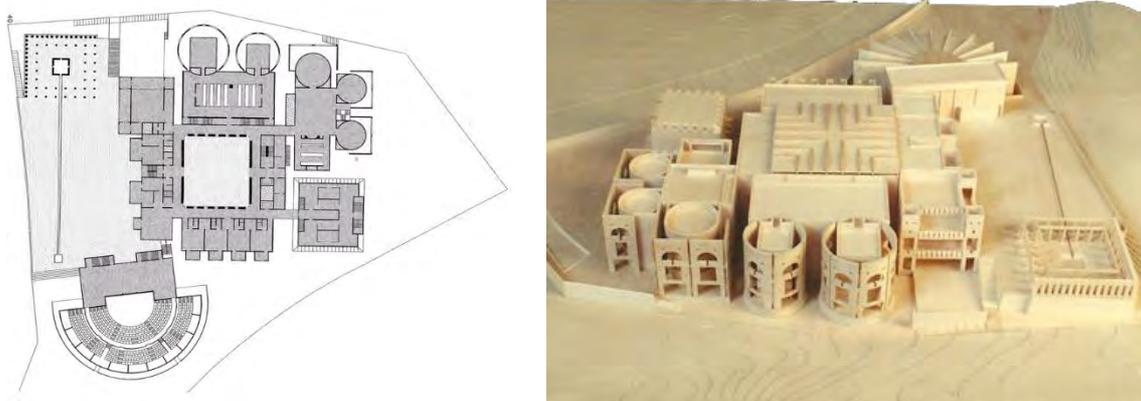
e 36 | Planta e maquete da Meeting House e as células espaciais [SHARP]
